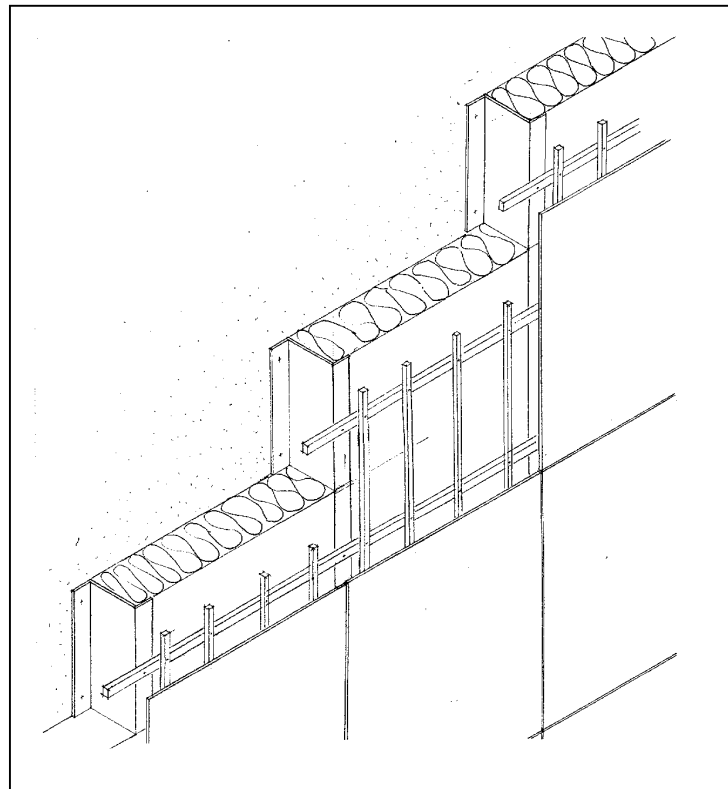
Isometrie Fassadenkonstruktion mit Z-Profilen
